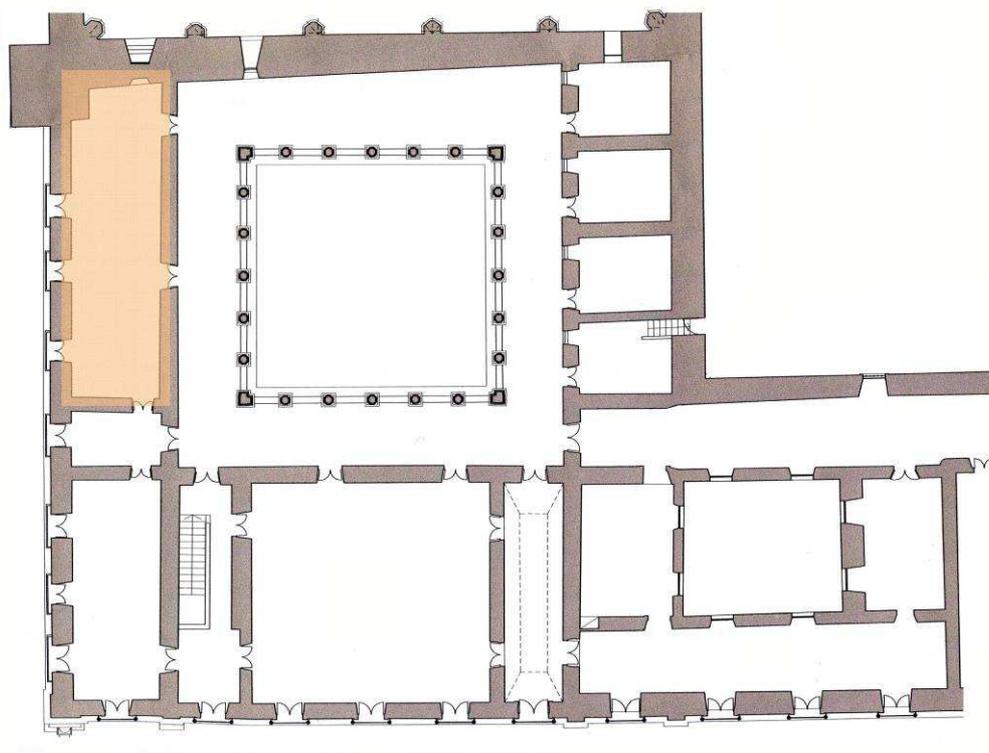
Localização das salas da galeria Norte na planta do piso superior do levantamento de 2003.
